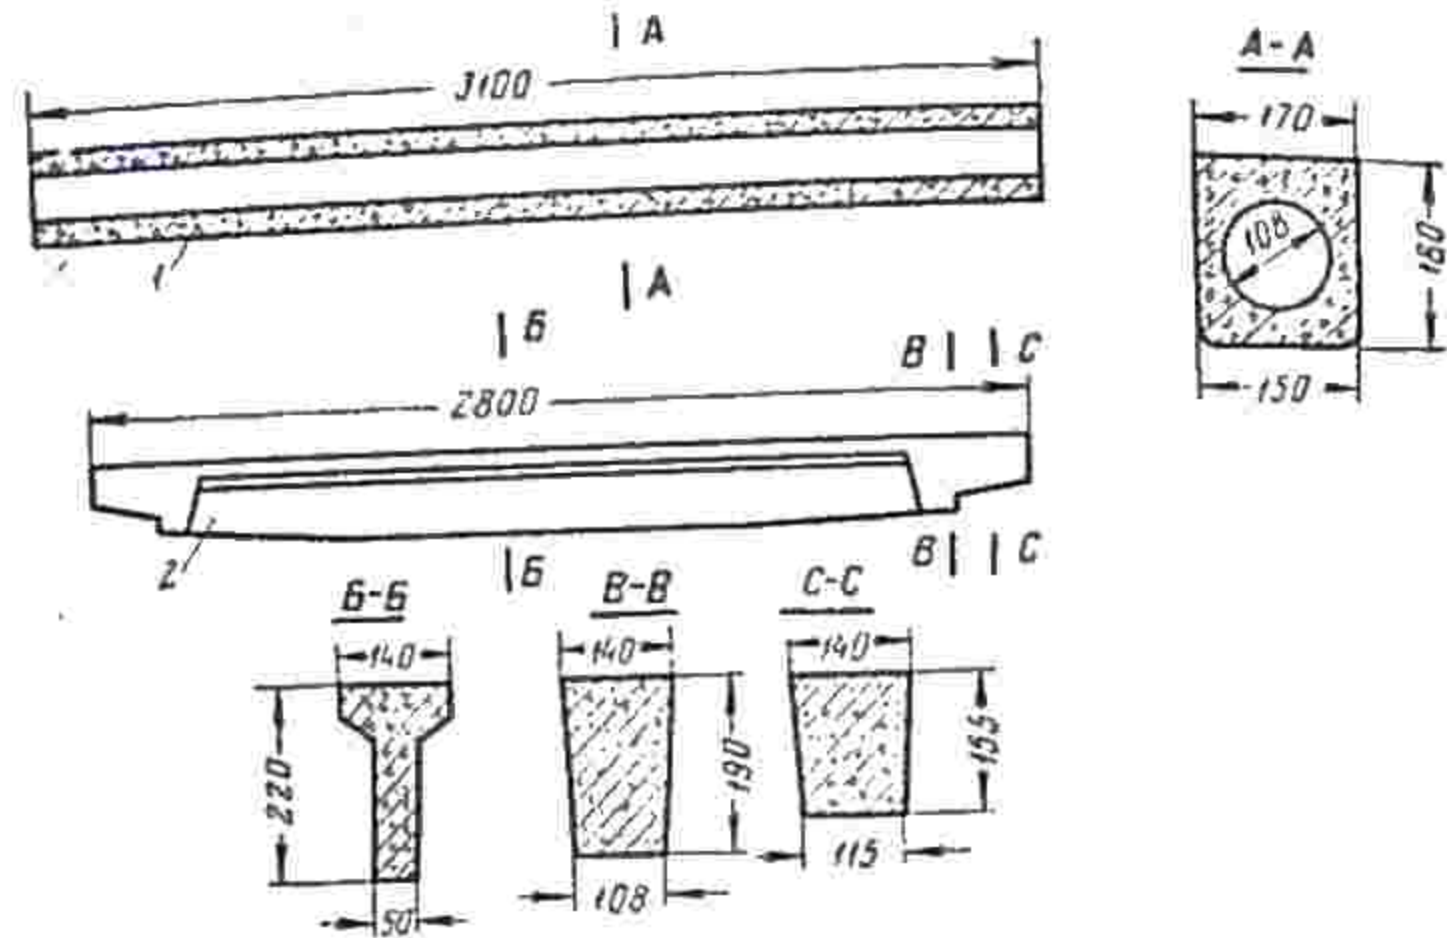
Элементы железобетонной рамной крепи из пустотелых стоек и таврового верхняка
